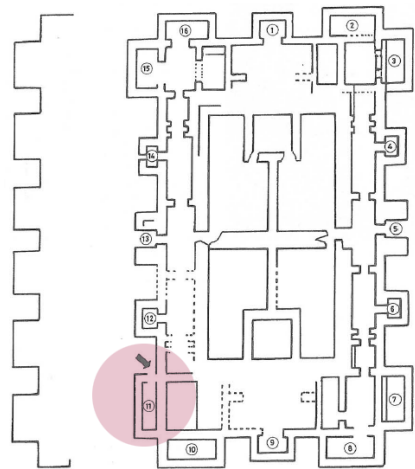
Planta de Torres Balbás sobre la que Navarro y Jiménez labran su idea de acceso.
